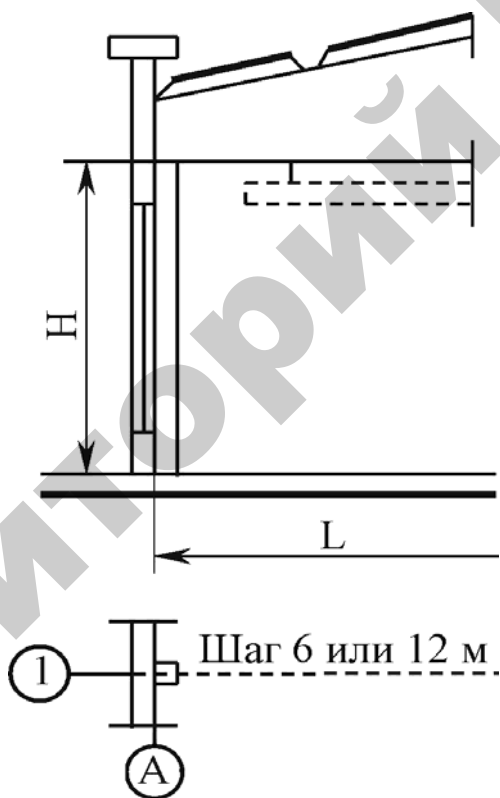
Привязка колонн стен каркасных зданий с подвесными кран балками
